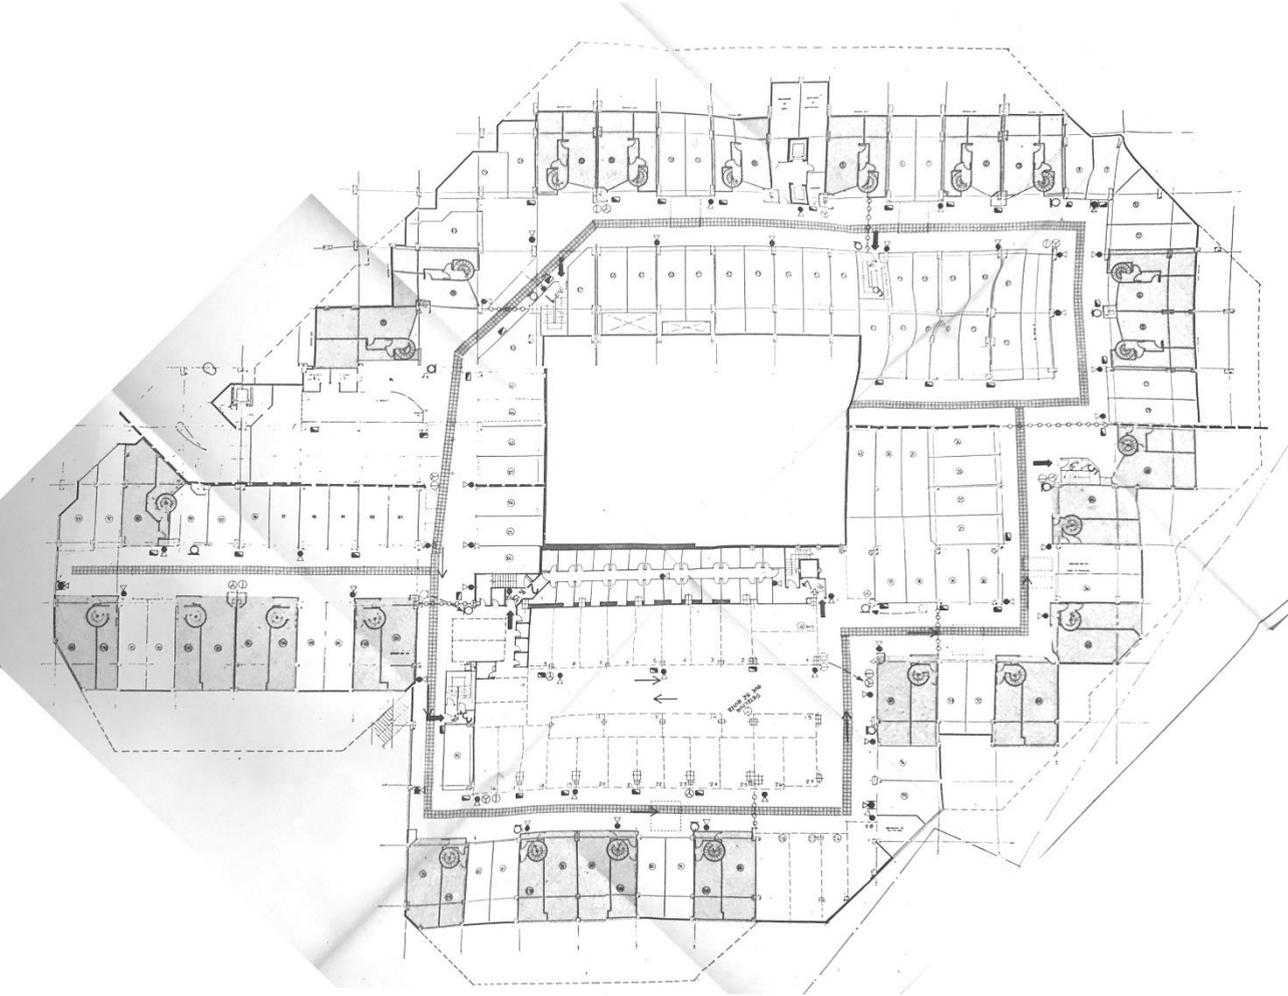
Plano planta sótano primera Proyecto Club Social y Piscina, CSPT. Fuente: Archivo Ayuntamiento de Valencia.
